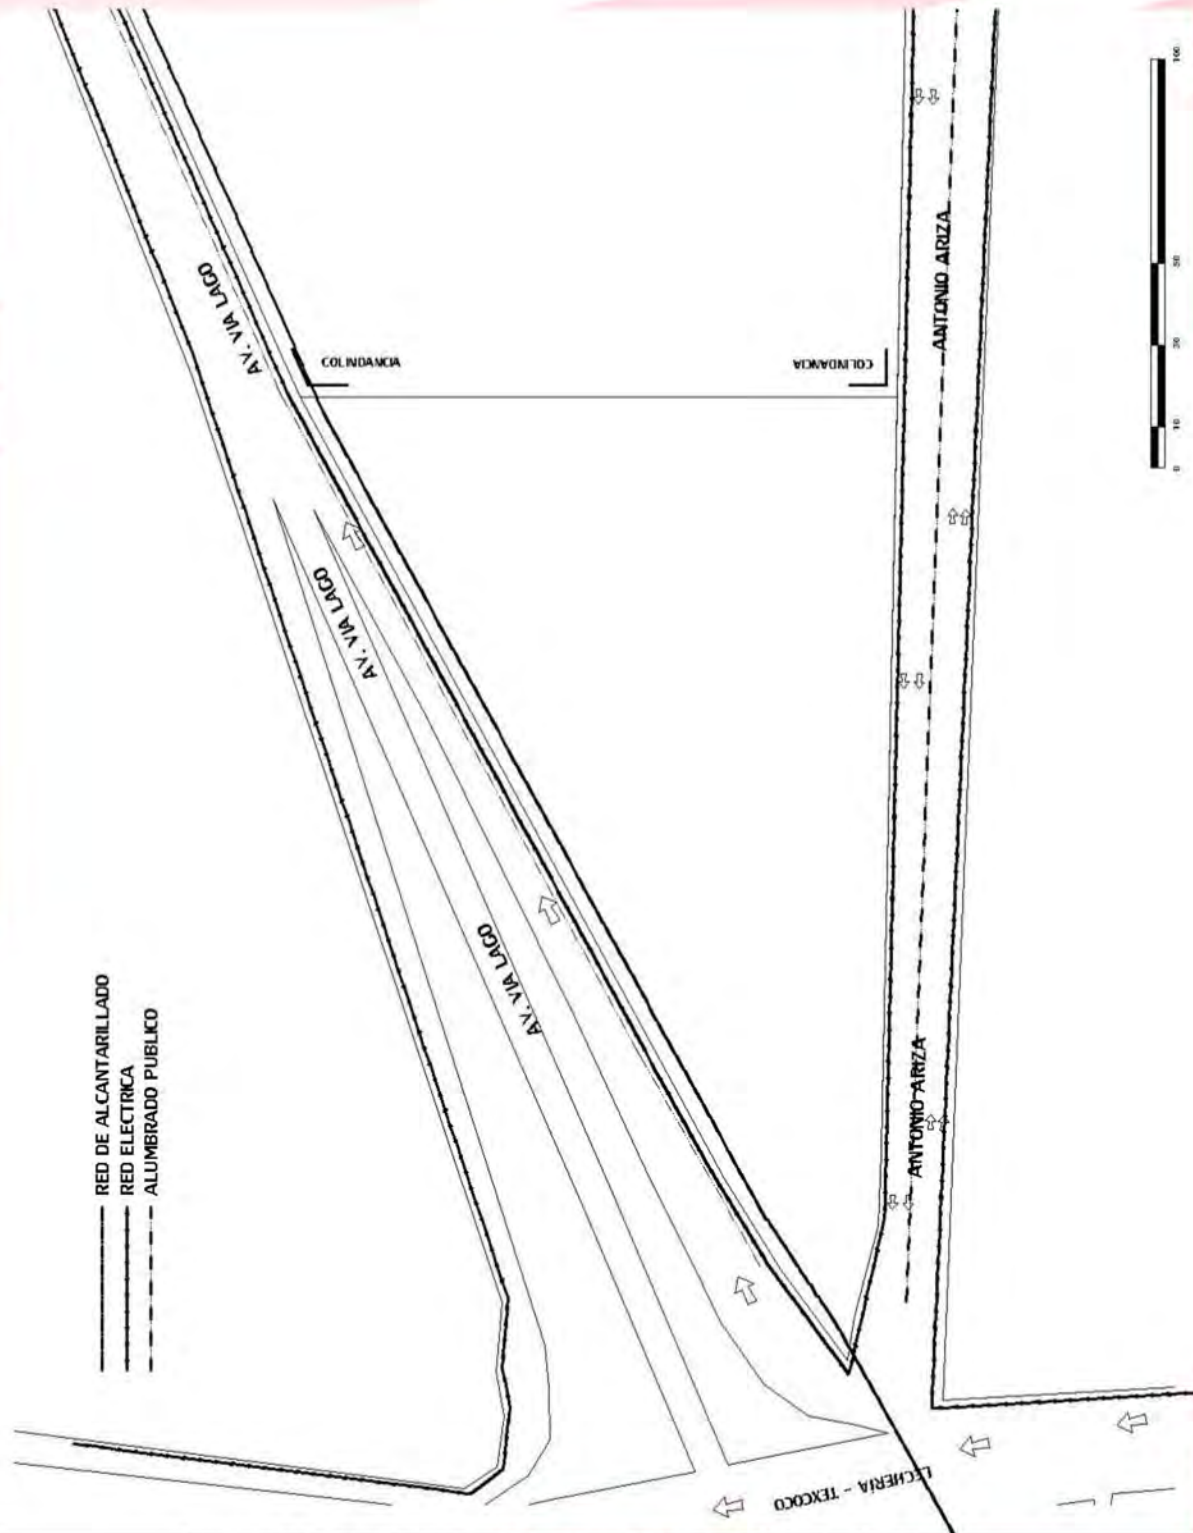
Servicios, Red Electrica, Drenaje y Alumbrado publico.
